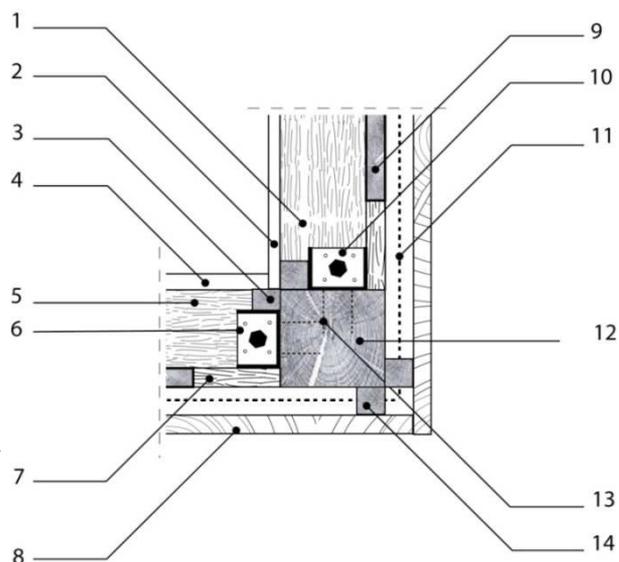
Coupe de principe d'assemblage d'angle de panneaux PST d'une maison à simple RdC.
